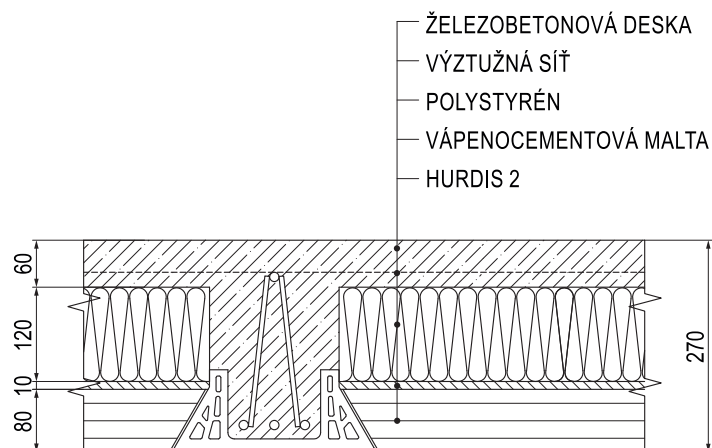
Keramický stropní nosník s příhradovou výztuží
